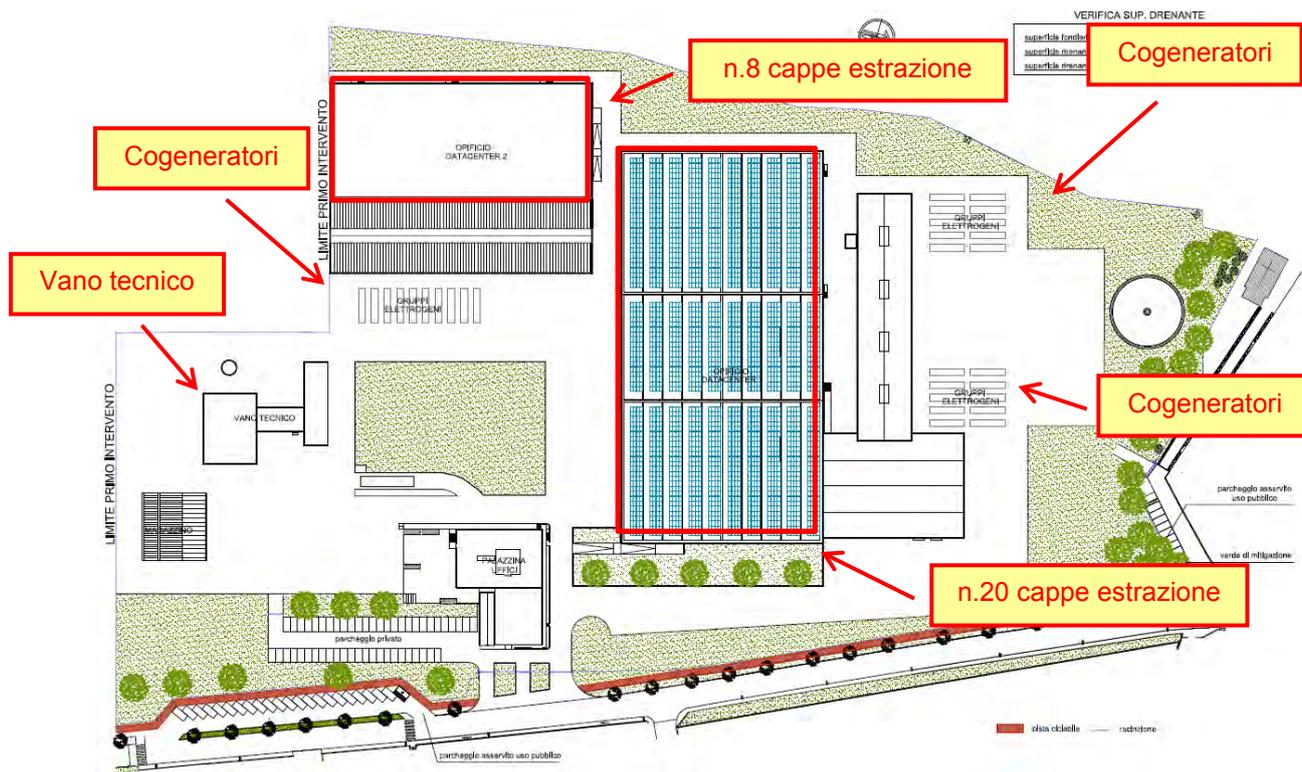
Stralcio planimetrico progetto Aruba con indicazione degli impianti individuati.
